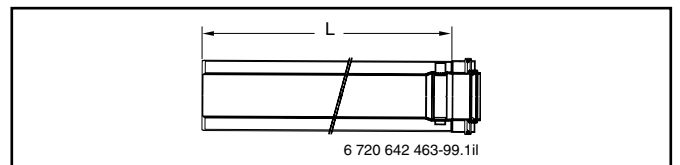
Tubo gas combusti Ø 80 (misure → tabella 77)
